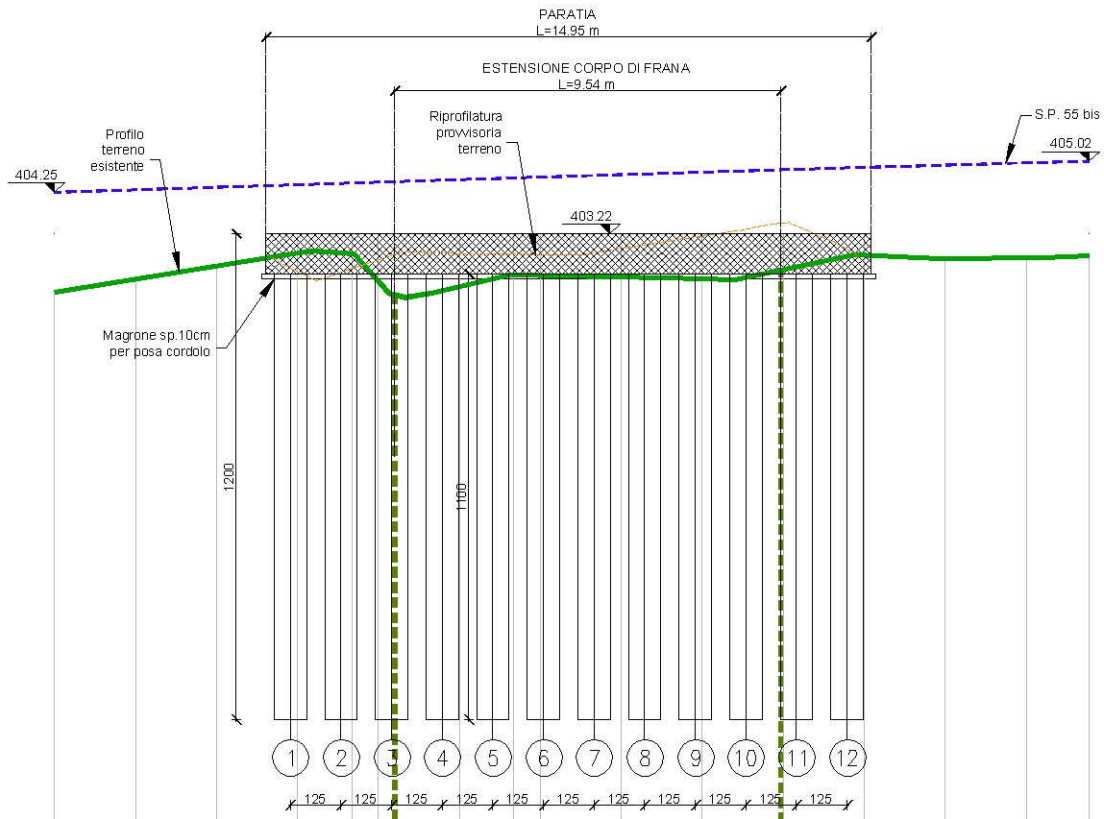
Stralcio planimetrico, prospettivo e sezione significativa della paratia
